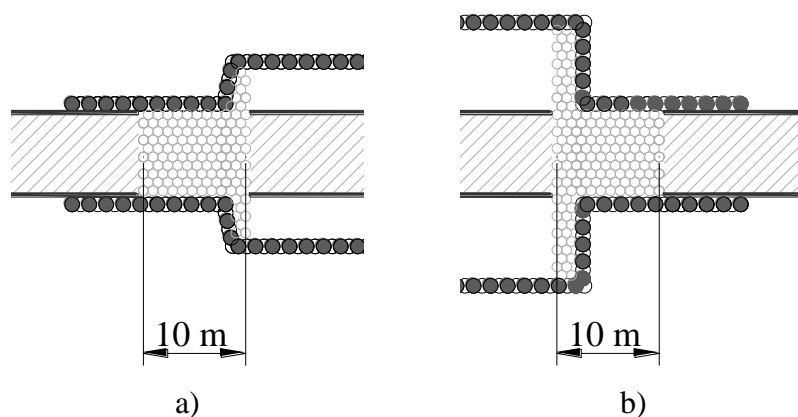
Vista em planta dos emboquilhamentos poente (a) e nascente (b) (adaptado de Cruz, 2006)
